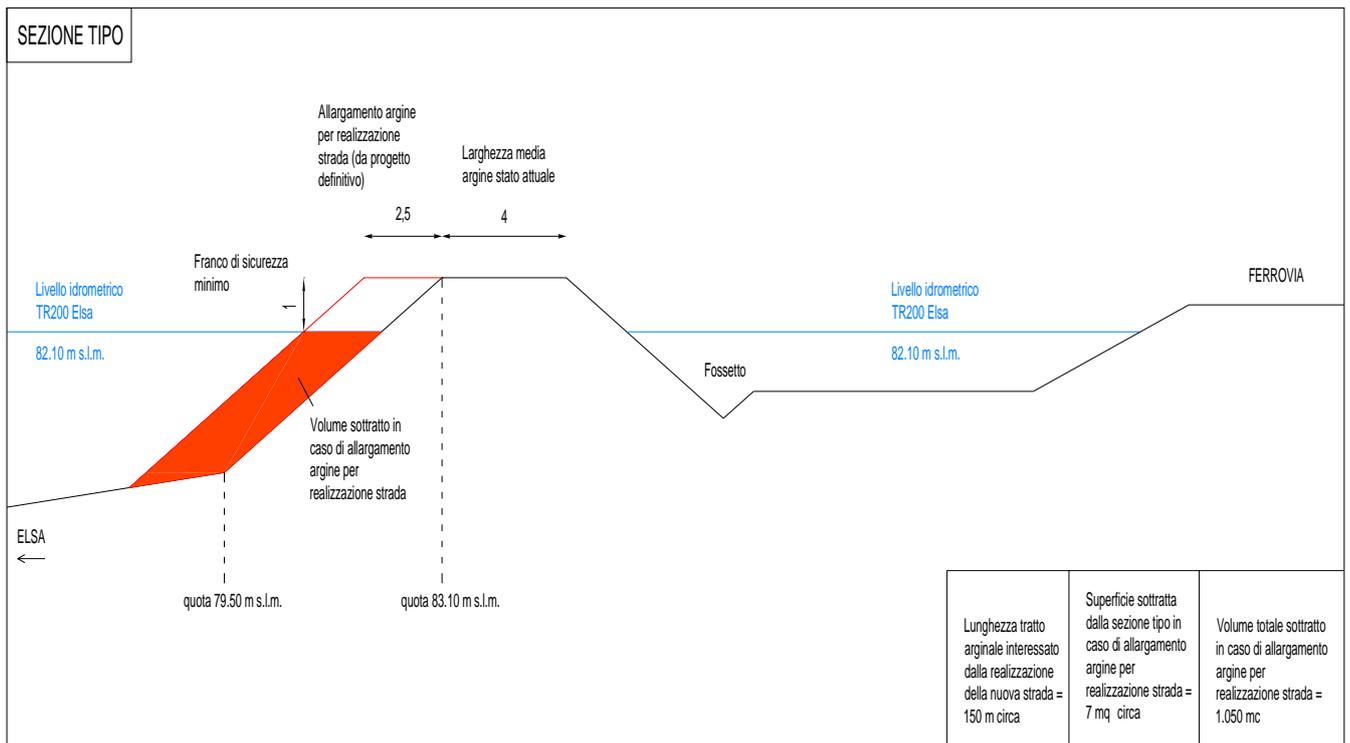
Sezione tipo della strada in studio con l'ipotetico allargamento considerato
